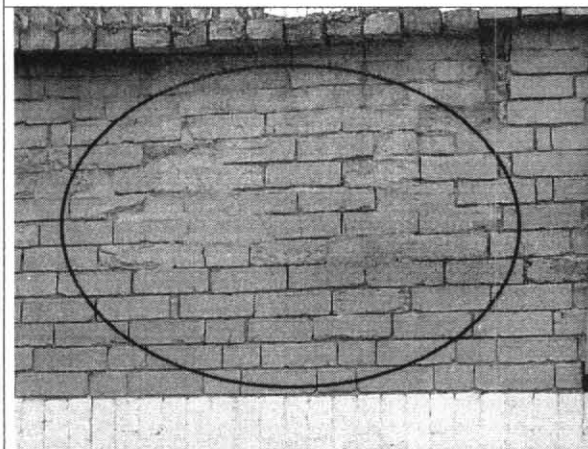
Agrietamiento leve del muro siguiendo el sentido de la pega.
